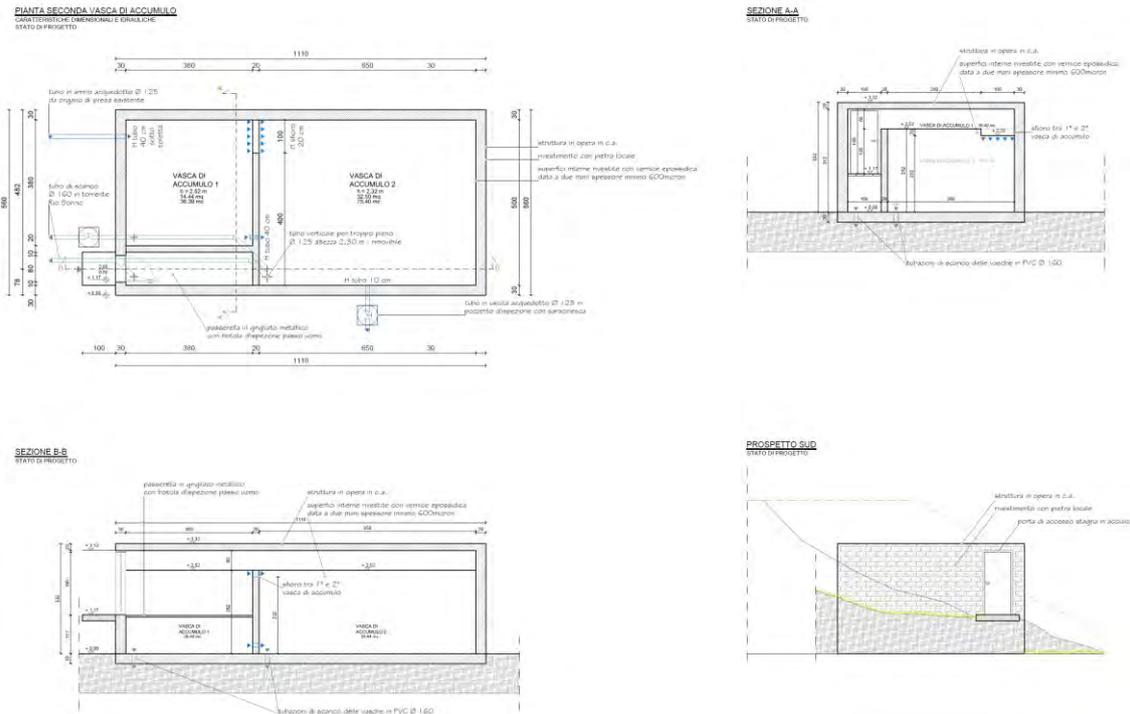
Planimetria e sezione di progetto della nuova vasca di accumulo
